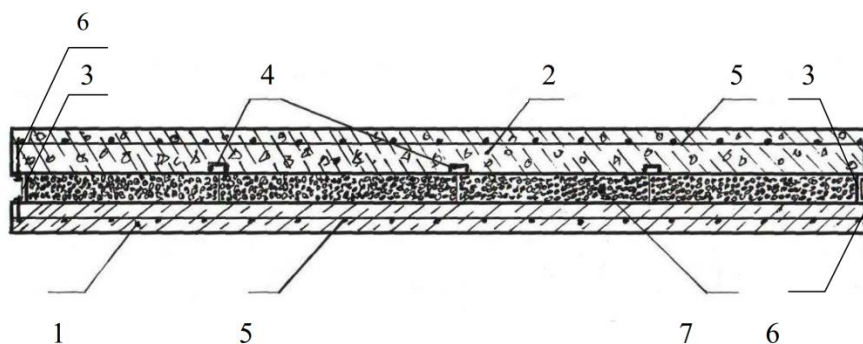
Трехслойная стеновая панель в разрезе: 1 – наружный бетонный слой; 2 – внутренний бетонный слой; 3 – каркас; 4 – перемычки; 5 – армирующие сетки; 6 – анкерные крепления; 7 – вакуумированная теплоизоляционная панель.
